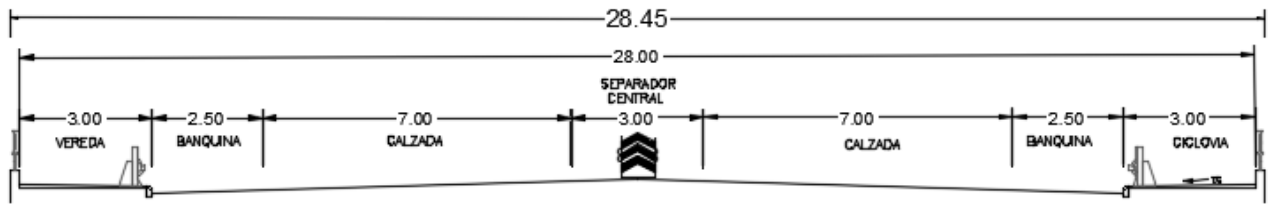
Esquema de la sección tipo del vial de calzada doble
